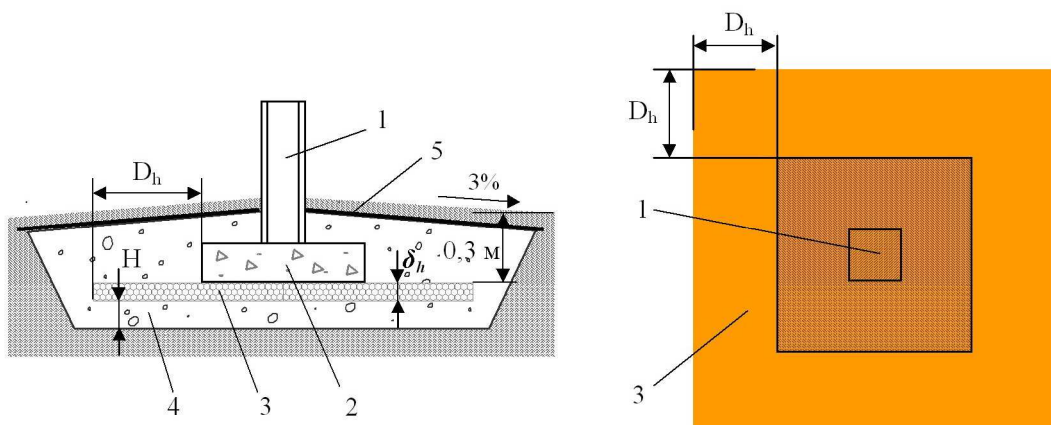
Схема укладки и параметры теплоизоляции «Пеноплэкс» в фундаментах отдельно стоящих опор
